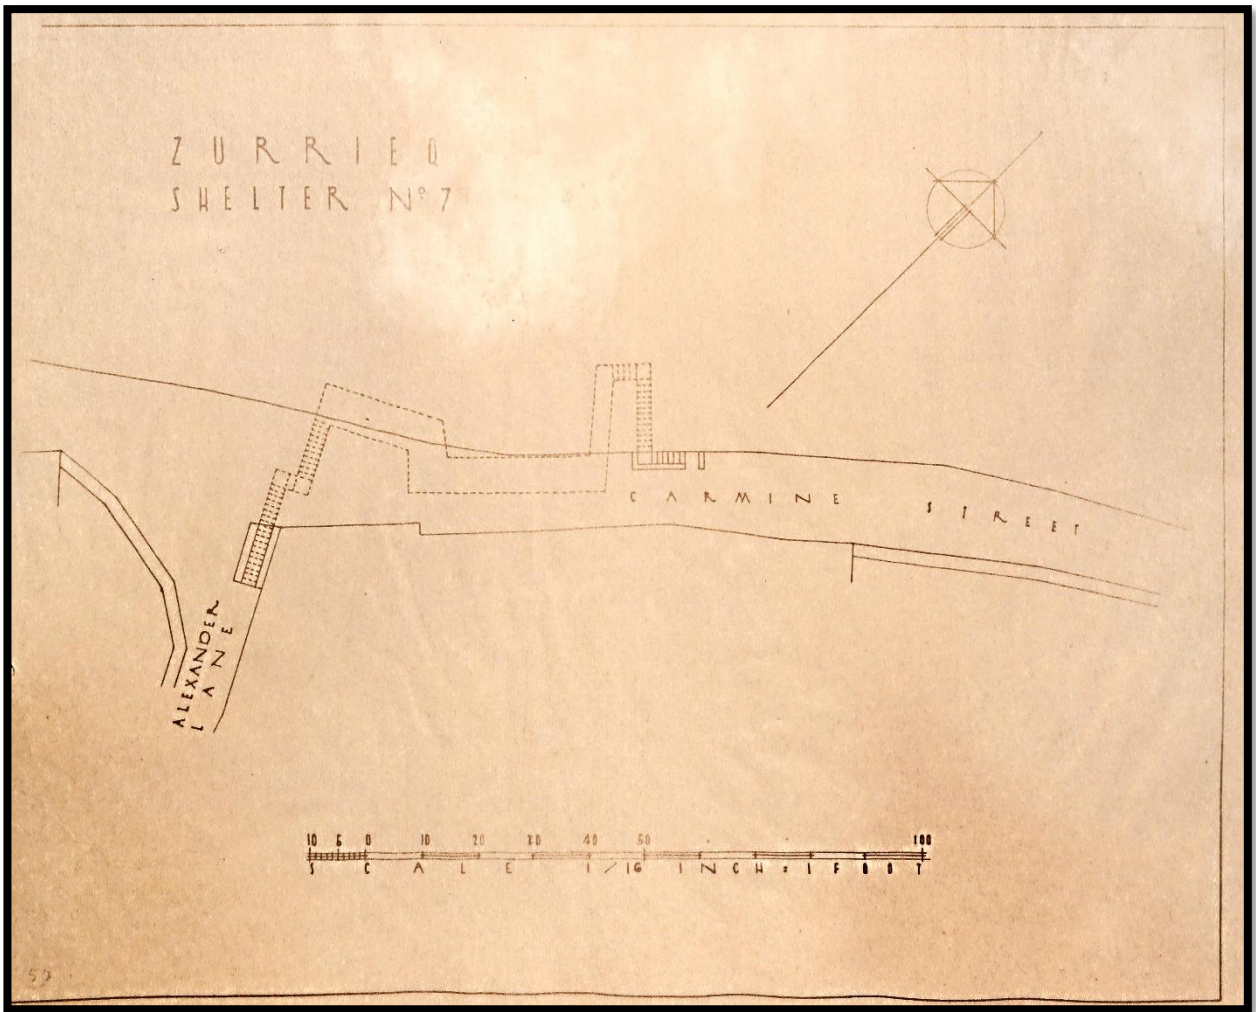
Planta do Abrigo nº7 "Carmel Street – Alexander Lane"
